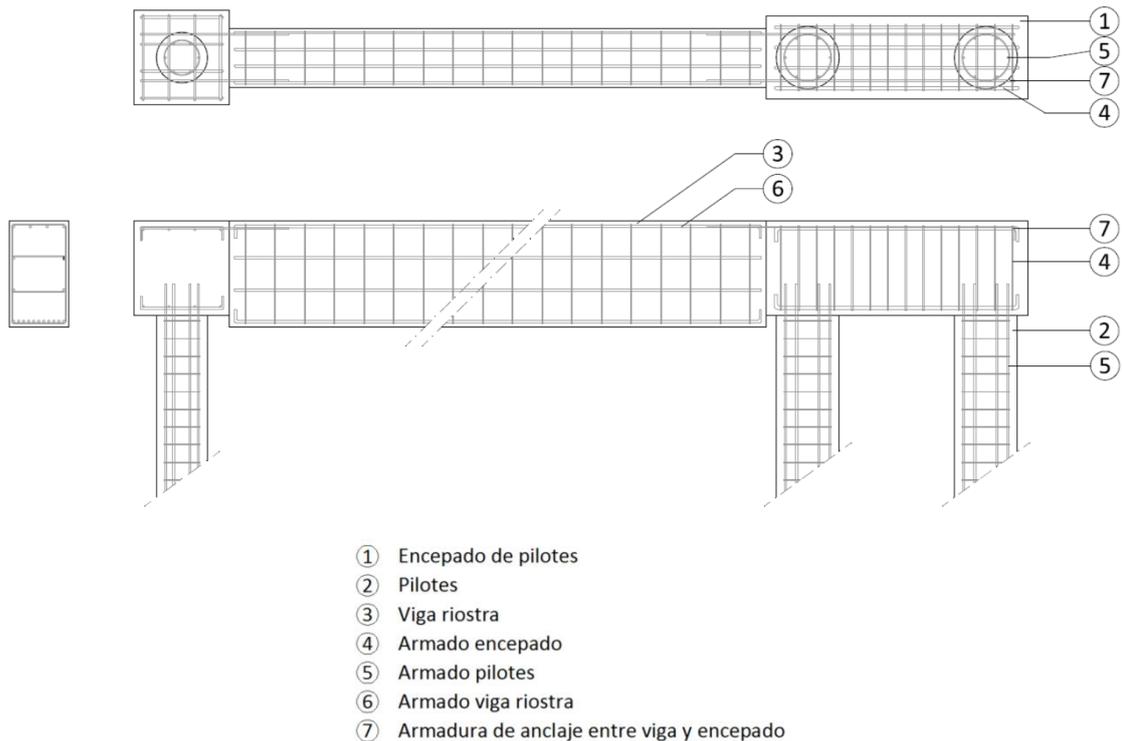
Detalle constructivo del armado de los pilotes y la viga riostra que los une. (Fuente: propia)
